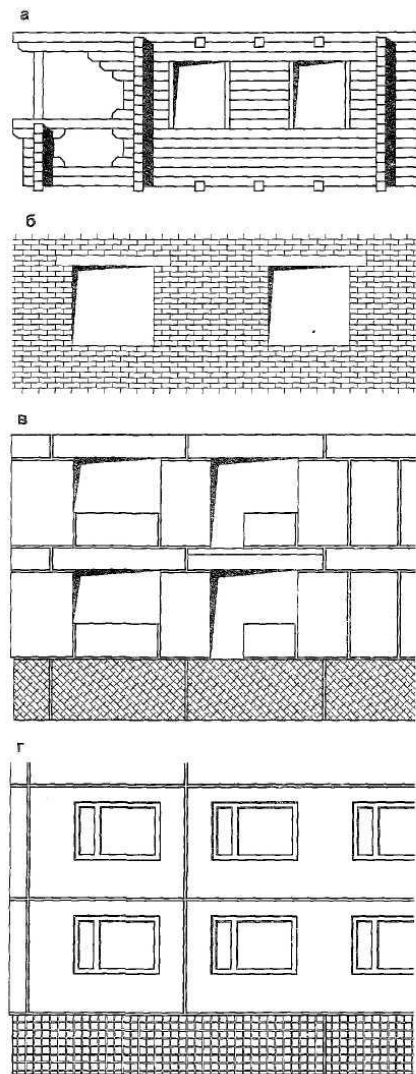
Примеры строительных систем (фрагменты фасадов зданий):
